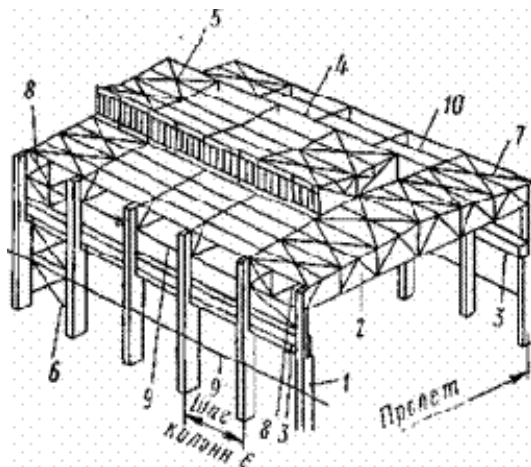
Основные элементы стального каркаса промышленного здания: 1 - колонна рамы; 2 - стропильная ферма (ригель); 3 - подкрановая балка; 4 - фонарь; 5 - связи фонаря; 6 - вертикальные связи между колоннами; 7- связи покрытия горизонтальные; 8 - то же, вертикальные; 9 - ригель; 10 - прогоны
